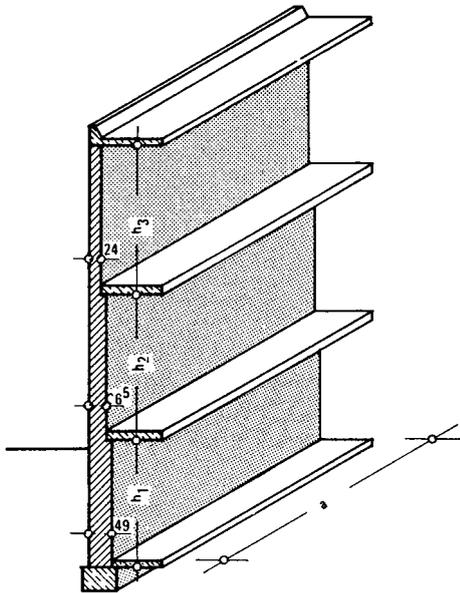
Außenwand aus Mauerwerk mit aufliegenden Geschossdecken
